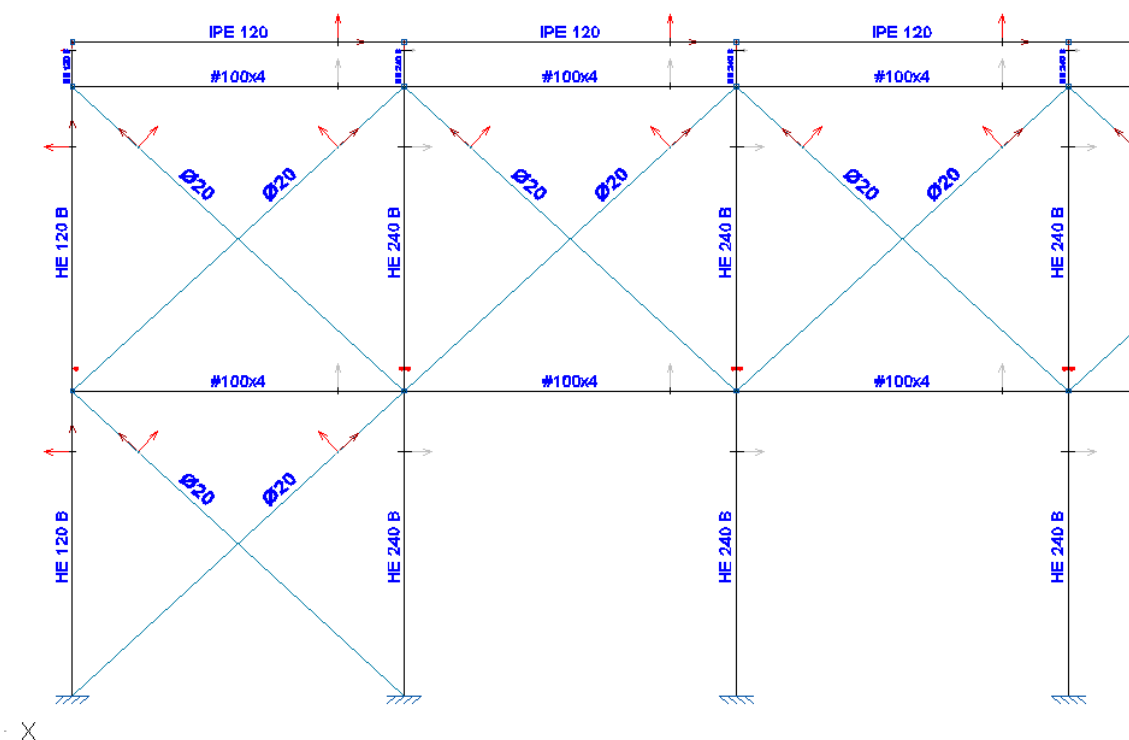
Vista ampliada de un sector de la fachada lateral
